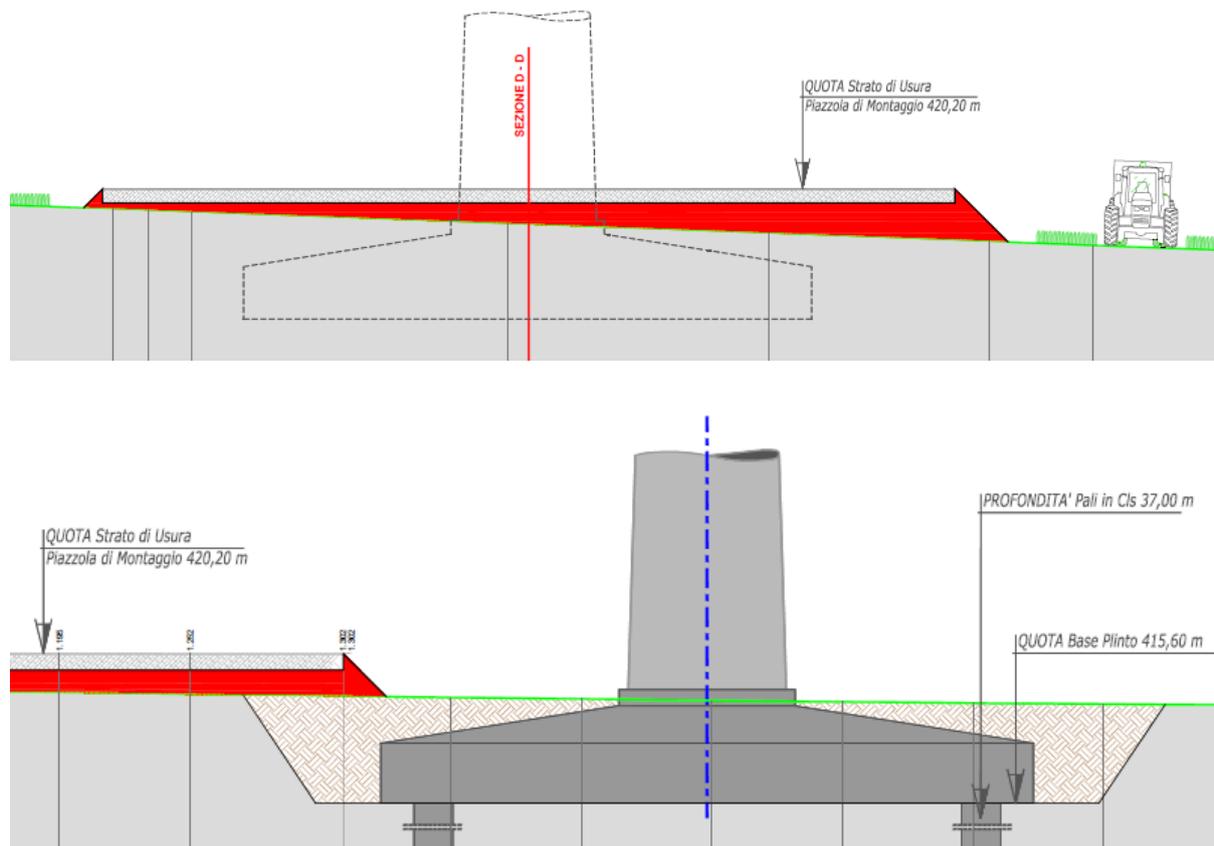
Esempio tipologico piazzola di montaggio e sezione di posa plinto fondazionale
